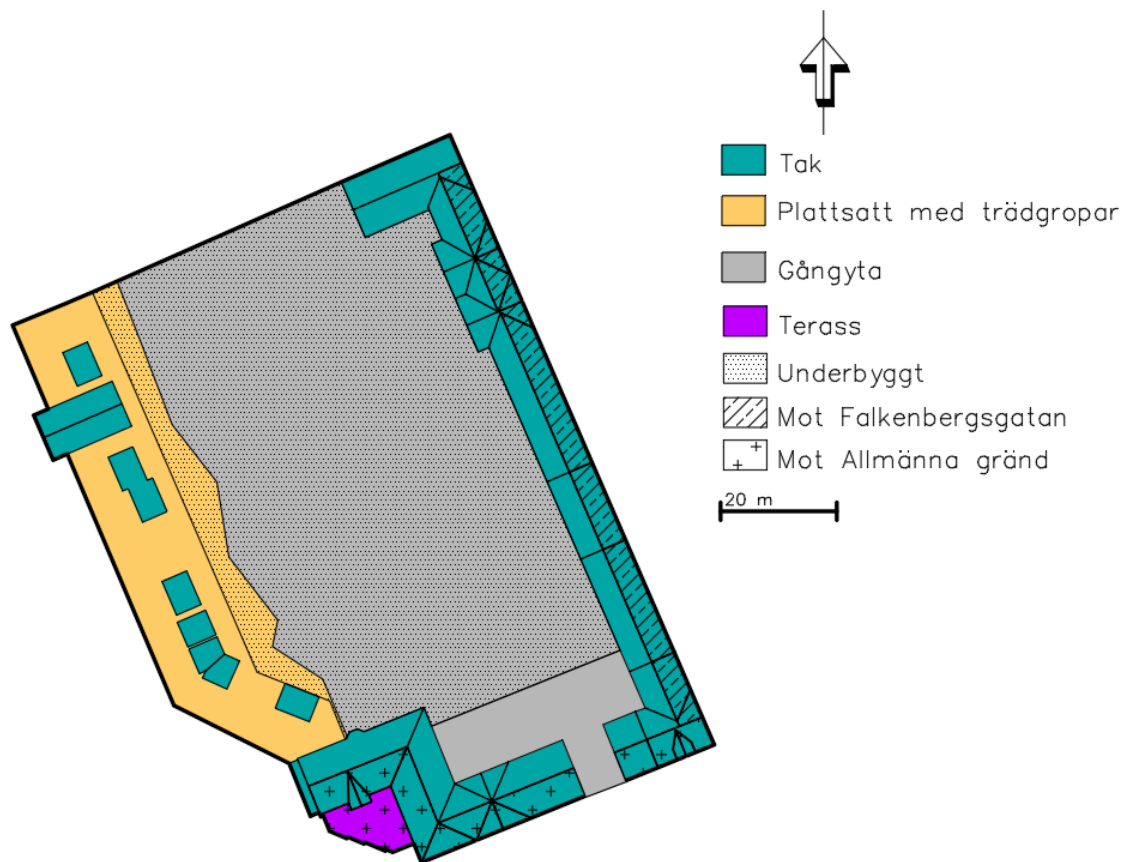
Situationsplan över planområdet. Underbyggt öster om den svarta streckade linjen.
